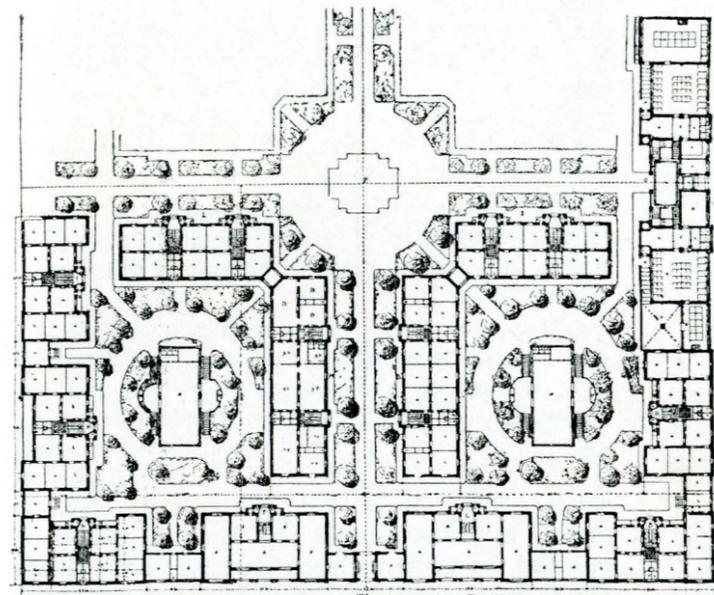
Planimetria generale delle case operaie dell'« Umanitaria ».
